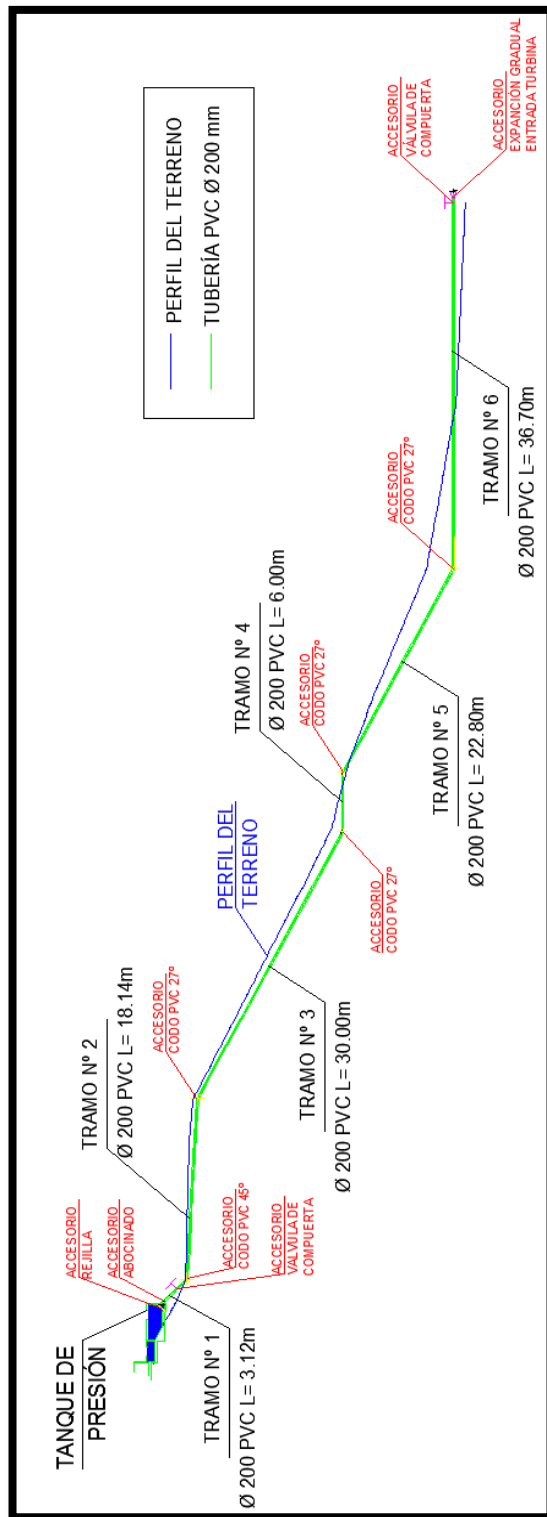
Perfil del terreno detalles de accesorios y longitudes de tuberías
